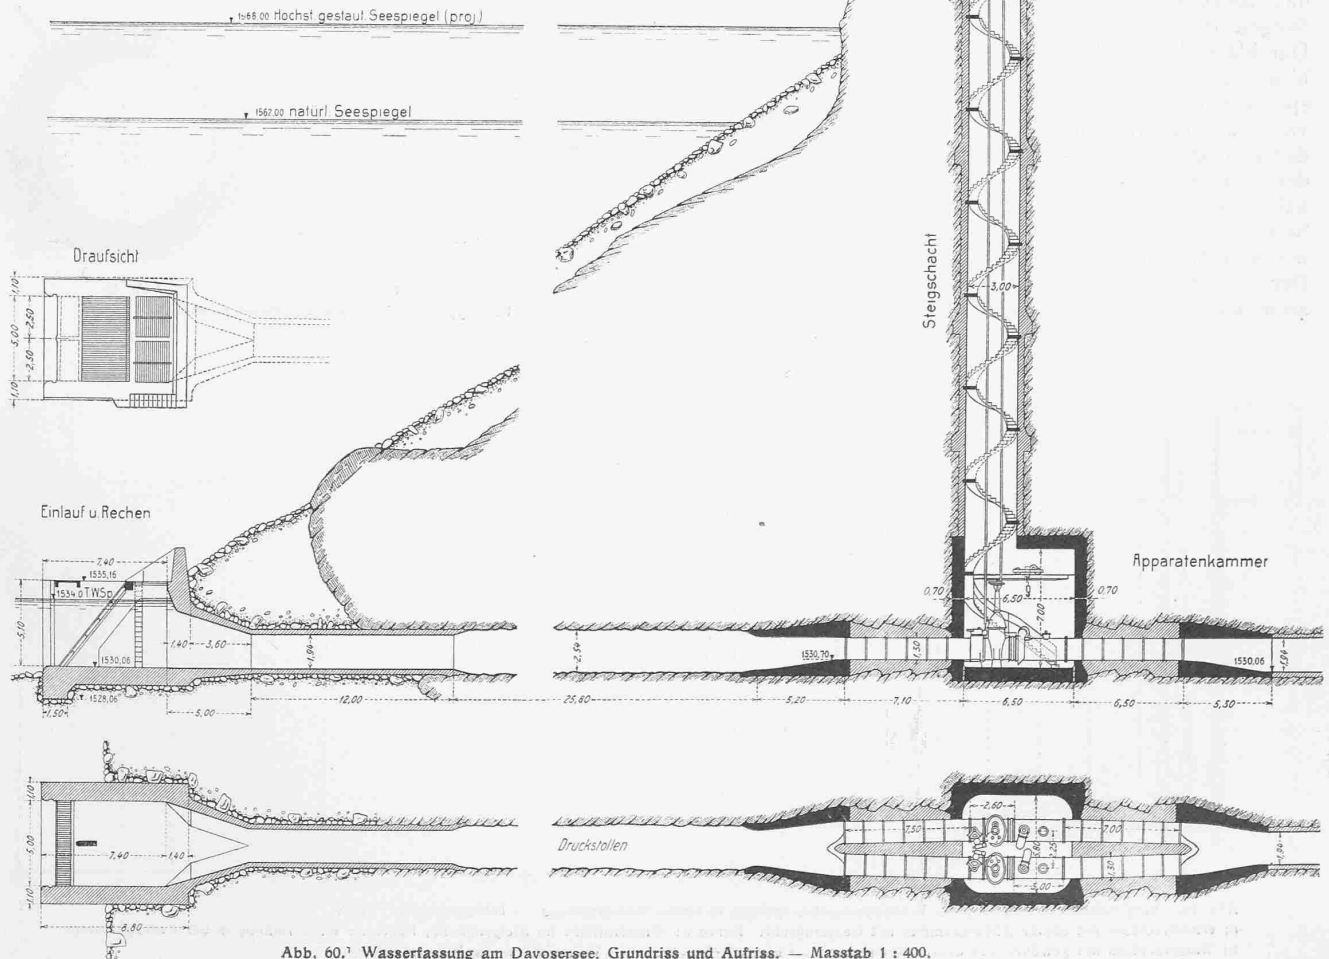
Wasserfassung am Davosersee; Grundriss und Aufriss. — Masstab 1 : 400.
